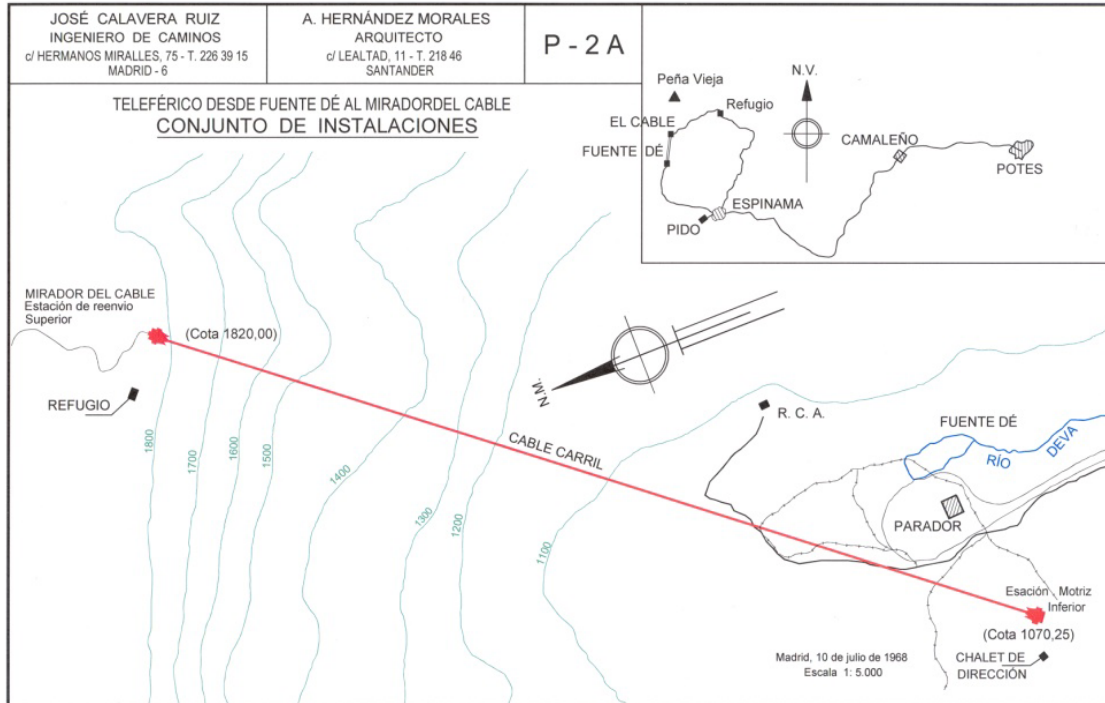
Planta con el conjunto de instalaciones alrededor del Teleférico.
